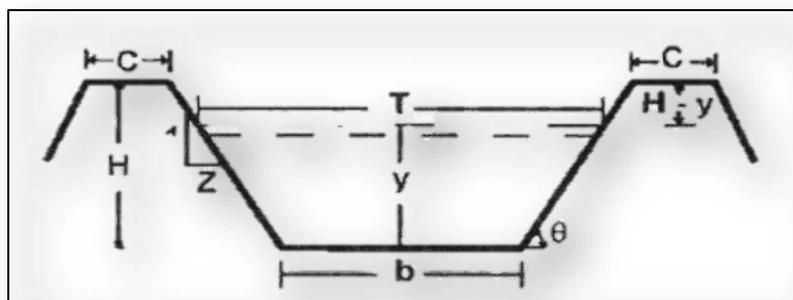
Elementos Geométricos en un Canal Trapezoidal. (Fuente: Villon,(2007)).
